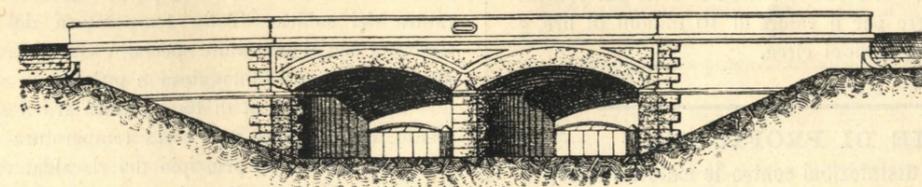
Prospetto parallelamente all'asse del Bussè.
